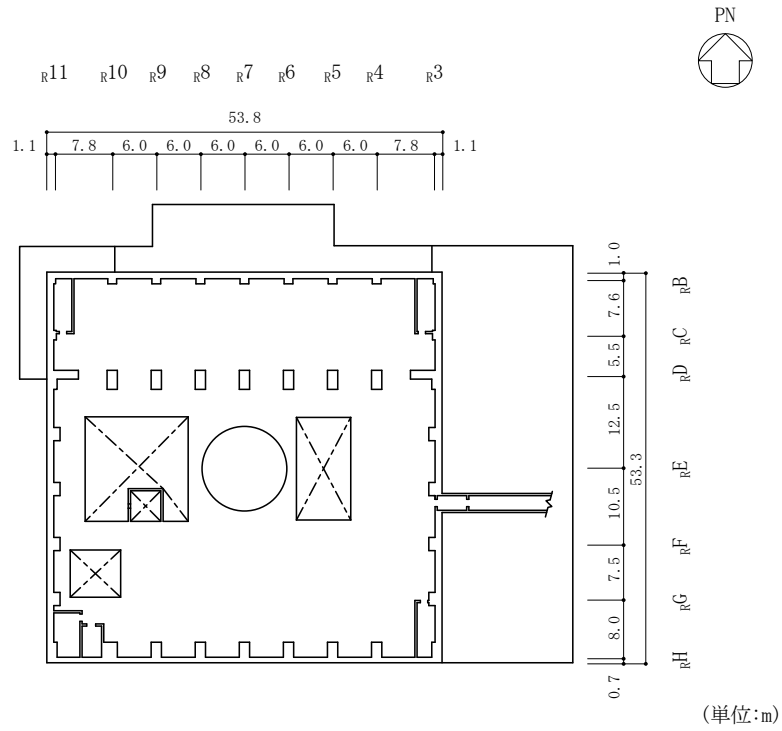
(7) 原子炉建物の概略平面図 (EL 42.8m)
